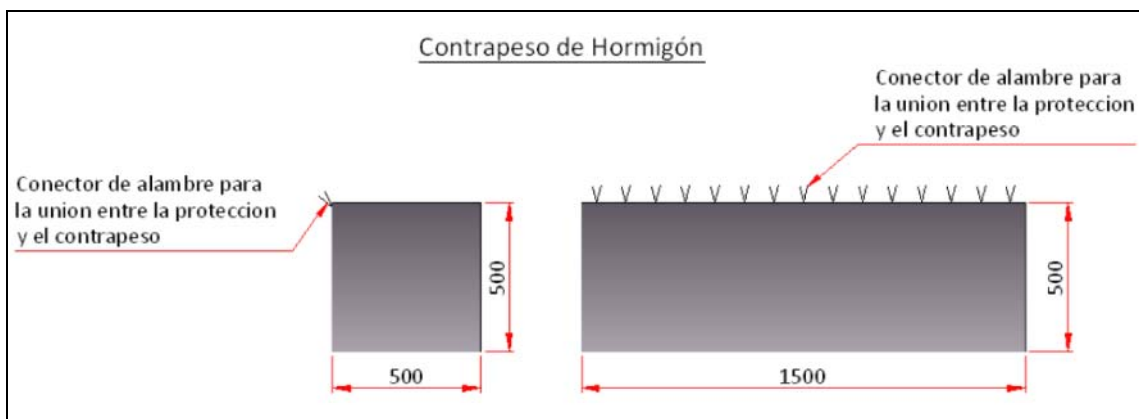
Detalles del contrapeso de hormigón – Medidas en (mm).
